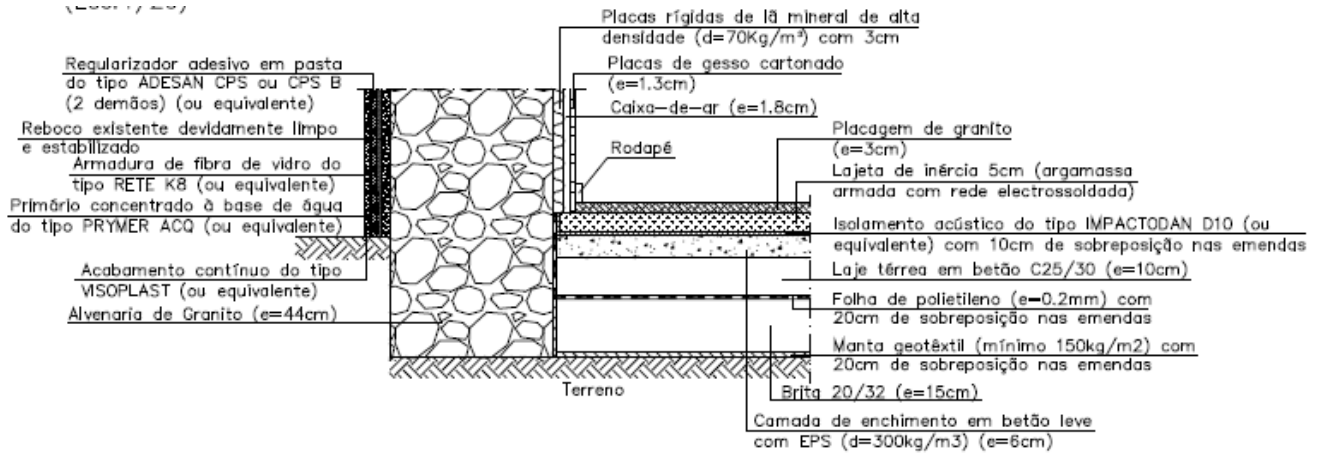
Pormenor de ligação entre a parede de fachada e o piso térreo (Projeto de CT)
